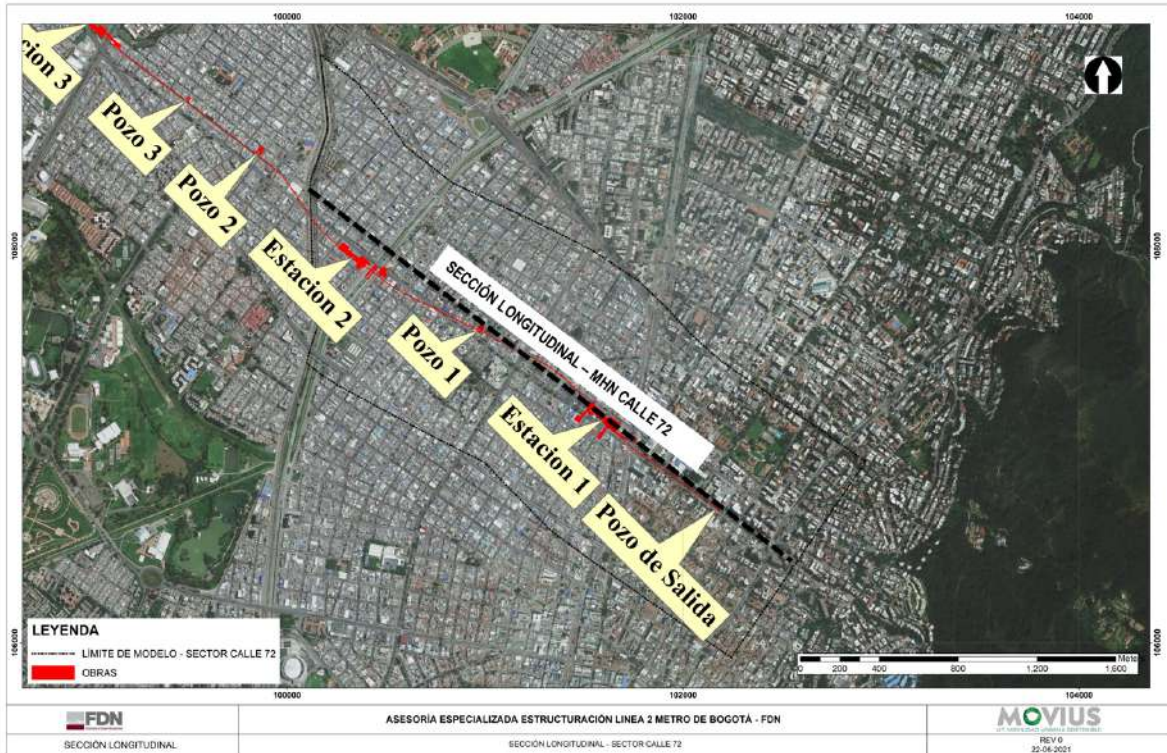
Ubicación en planta sección longitudinal - Sector Calle 72 , Columna 70 del modelo.
